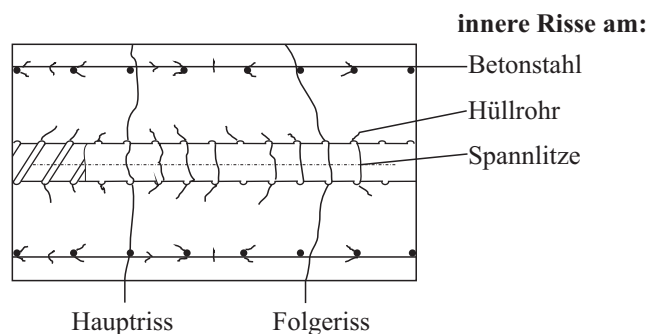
Inneres Rissbild eines Spannbetonbauteils
